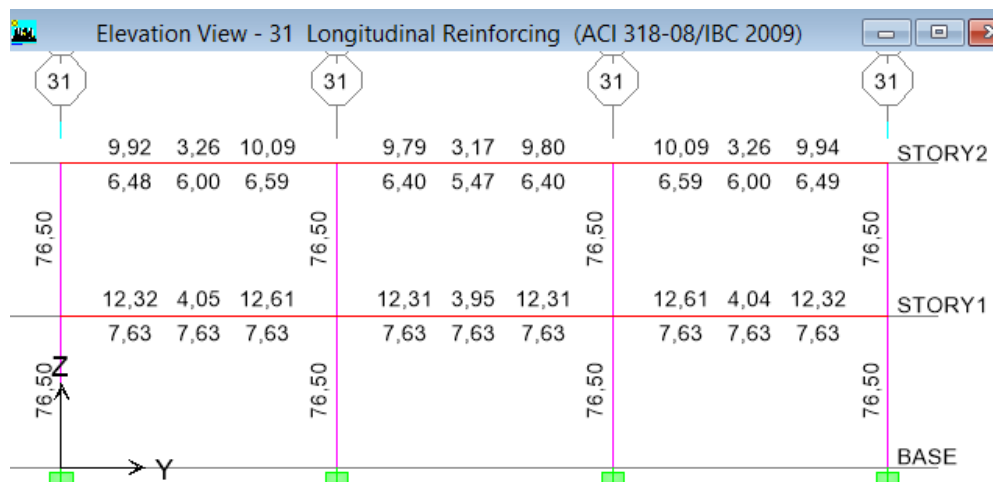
Acero en Vigas y Columnas en el Pórtico 31 – Obstetricia- (CEC2002)
